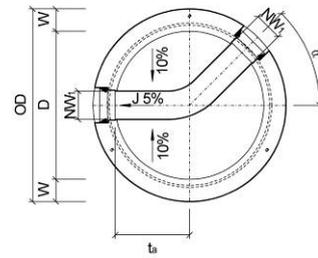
Grundriss CRENO Normschachtboden Typ 12
